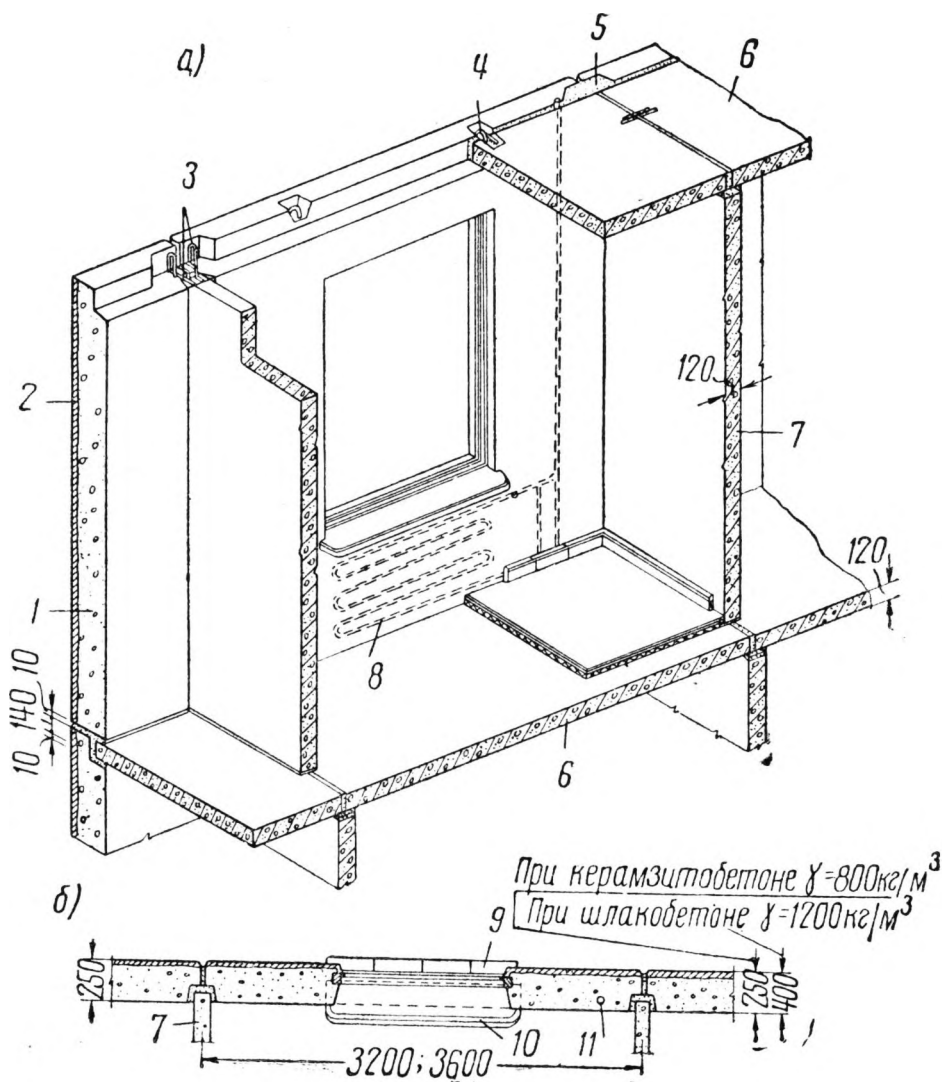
Сопряжение стены с перекрытием и перегородкой
